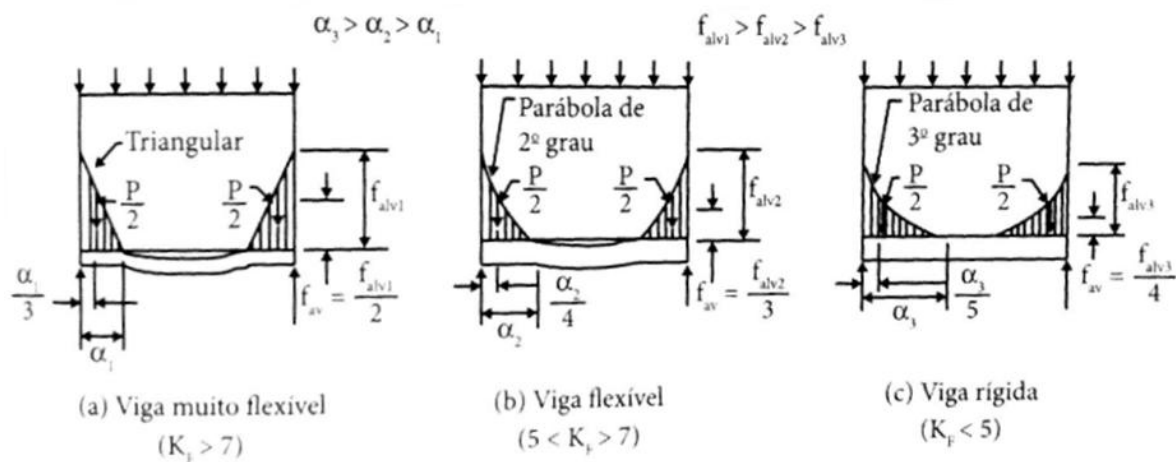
Distribuição da tensão de compressão vertical sobre os comprimentos de contato entre a alvenaria e a viga de apoio. (PARSEKIAN, 2013)
